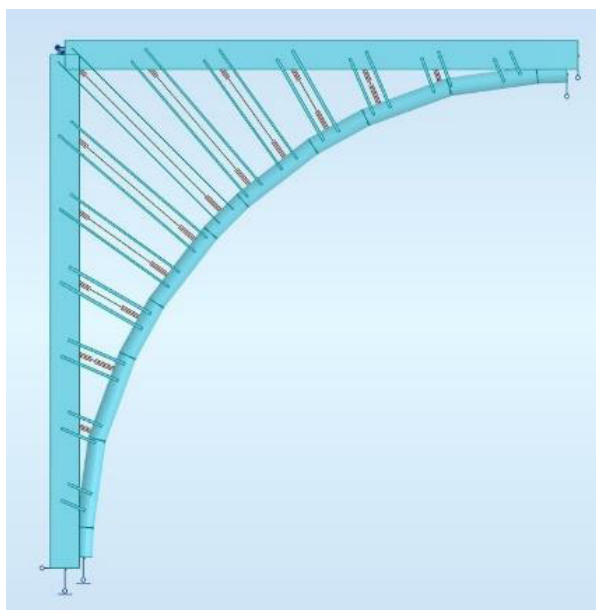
Planta do modelo da estrutura no Robot 2016.
